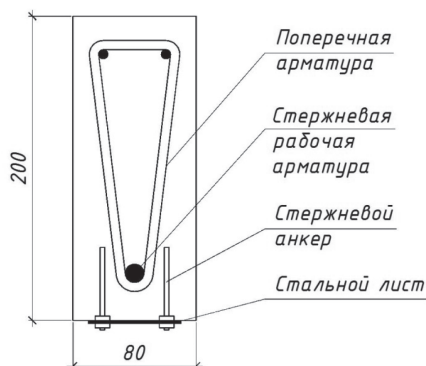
Схема армирования сталежелезобетонных балок-моделей
